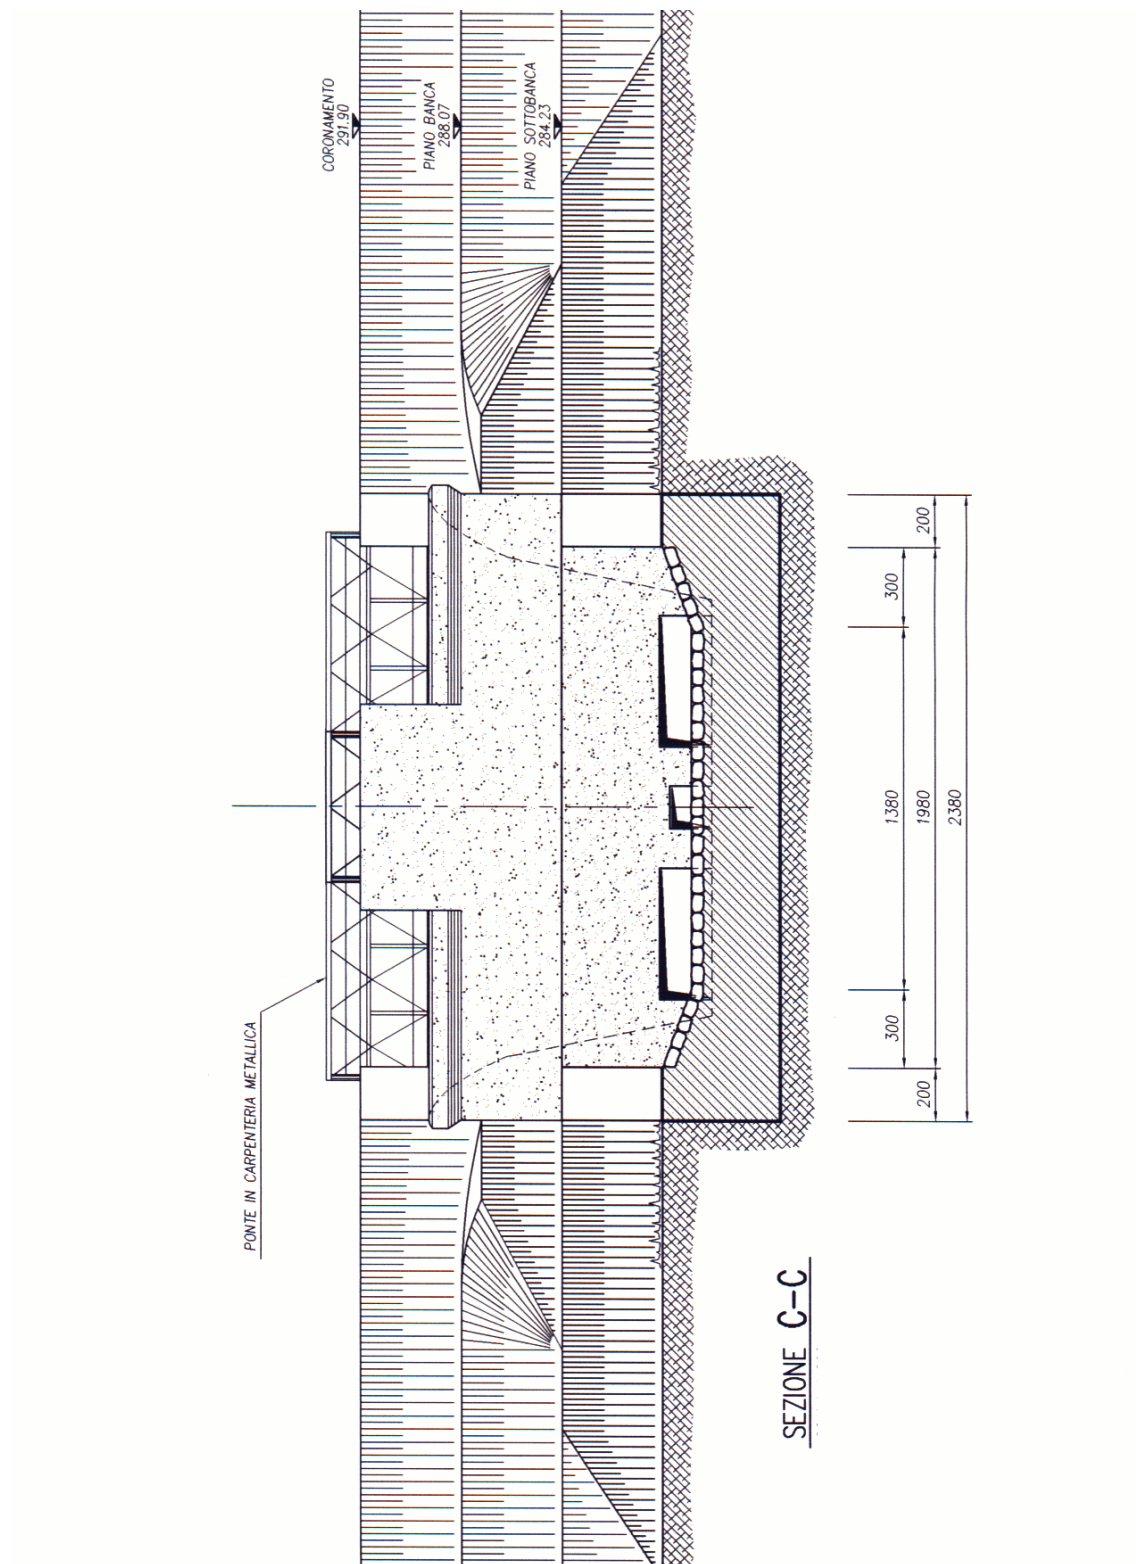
Sezione trasversale della traversa della cassa di espansione sul fiume Olona
